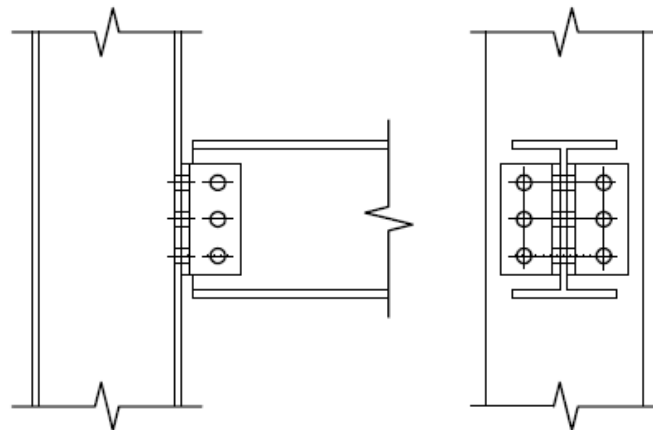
ligação flexível com duas cantoneiras aparafusadas na viga e na coluna
